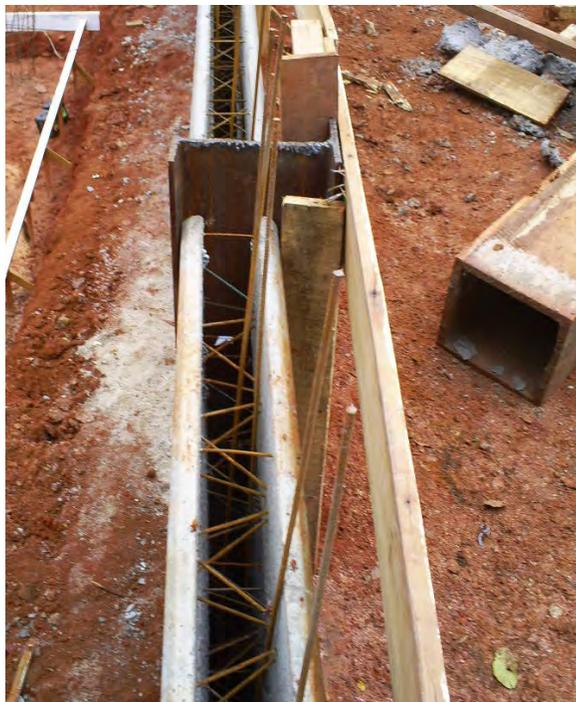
Cortina pronta para a concretagem com os ferros verticais já colocados;
